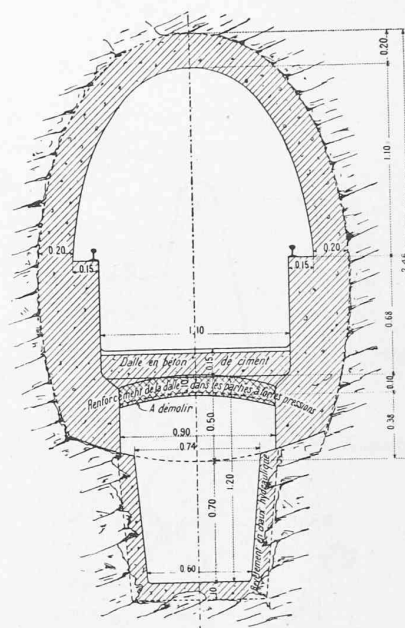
Section normale des tunnels d'adduction des eaux du Pays d'Enhaut.
